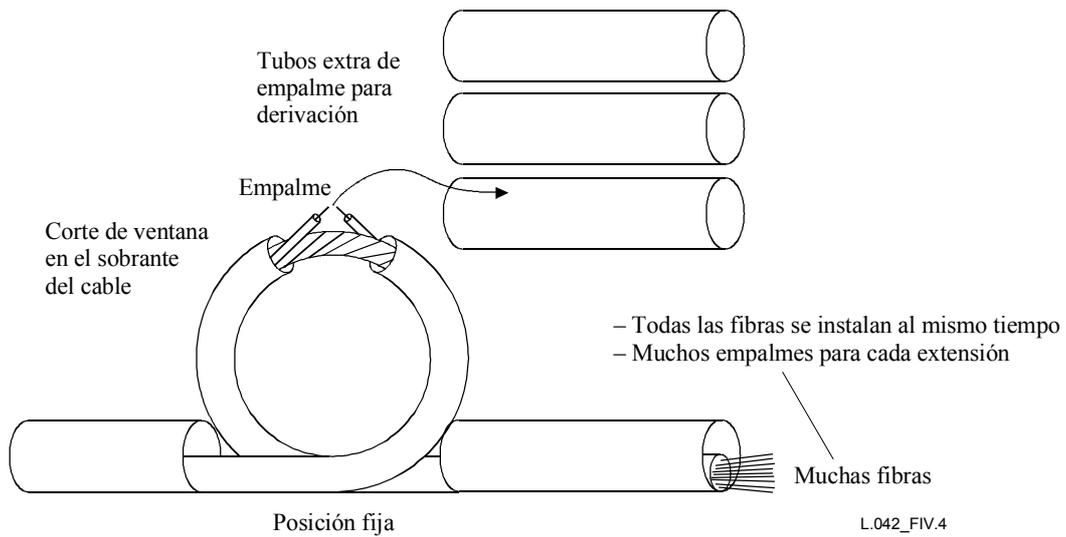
/L.42 – Punto de empalme con sobrante de cable en el caso del cableado óptico tradicional
